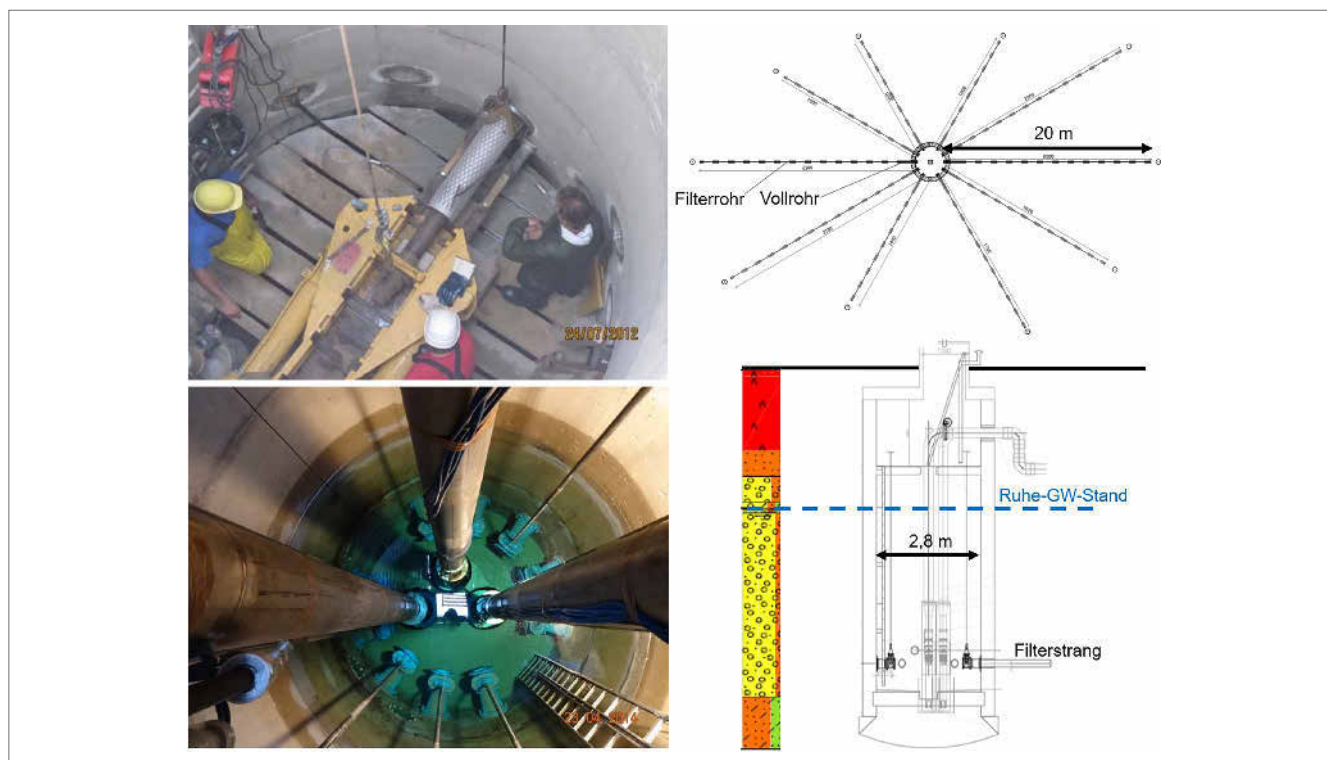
Links, oben: Herstellung des Horizontalfilterbrunnens nach dem Ranney-Falley-Verfahren. Links, unten: Fertiger Brunnen mit den drei Pumpen. Rechts, oben; Grundriss des Horizontalfilterbrunnens. Rechts, unten: Schnitt durch den Horizontalfilterbrunnen
